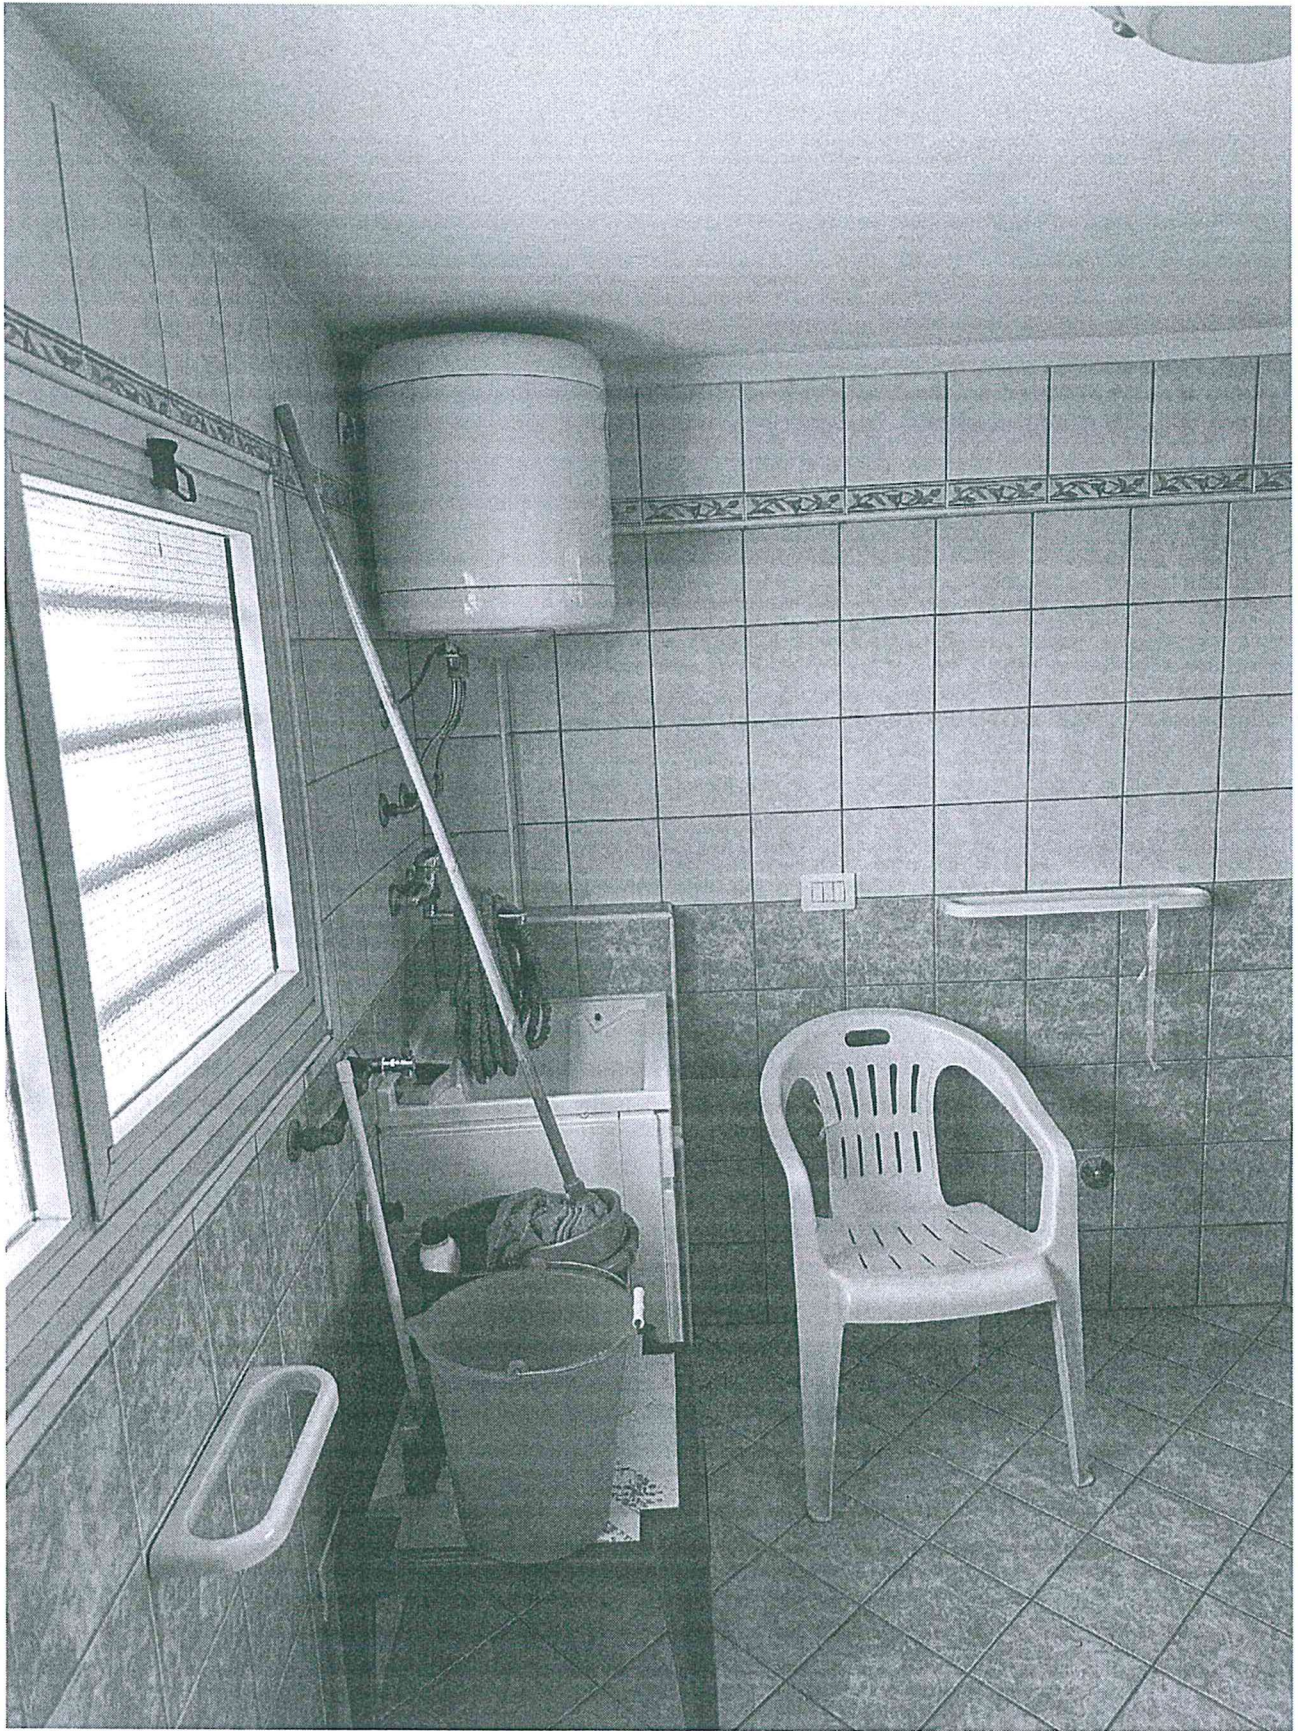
Interno Bagno posto all'interno del Box / Auto
